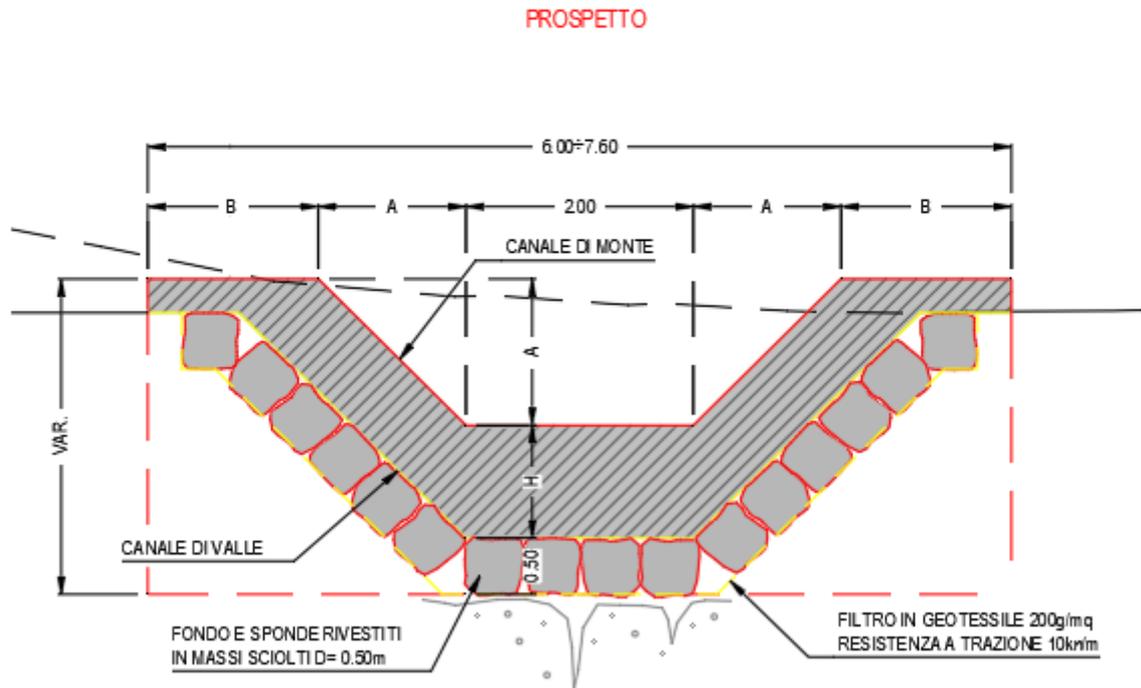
Inalveazione IN02 – sezione rivestita in massi naturali con salto di fondo in calcestruzzo gettato in opera
